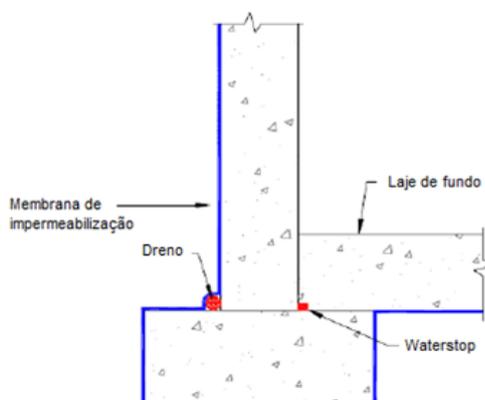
Continuidade do sistema de impermeabilização da fundação (Mendes, 2011)
